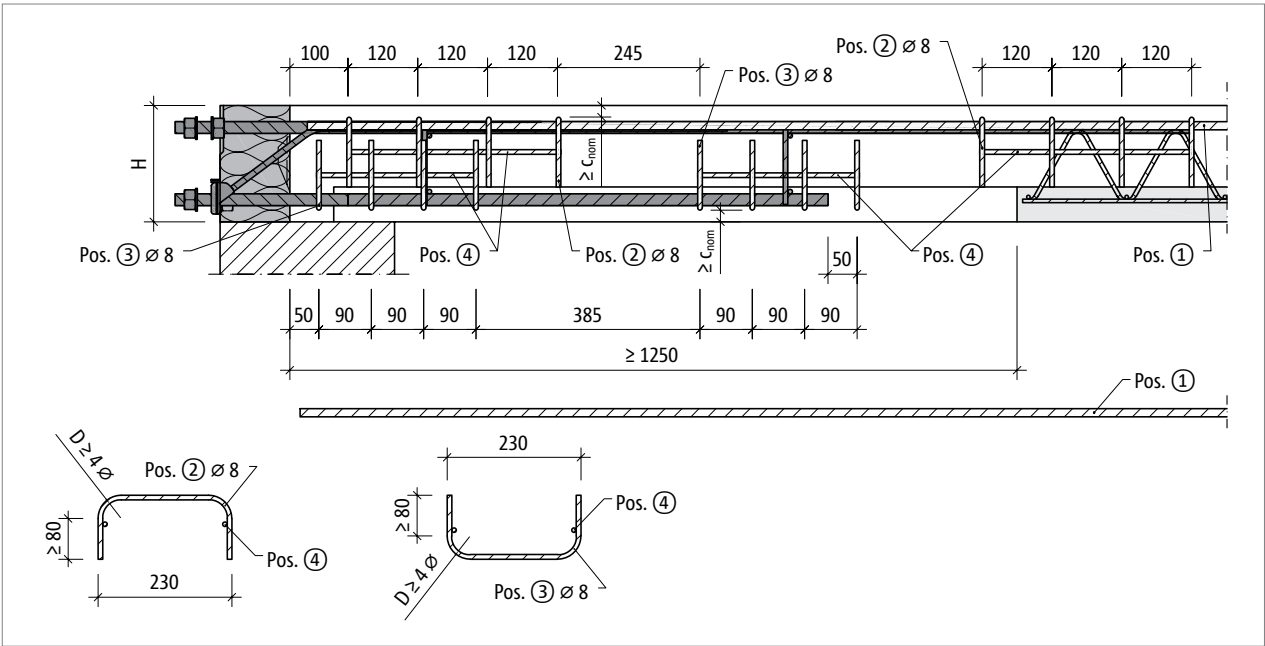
Schöck Isokorb® XT Typ SK-MM2: Bauseitige Bewehrung bei Halbfertigteilbauweise mit Bügel Ø 8 mm; Schnitt
